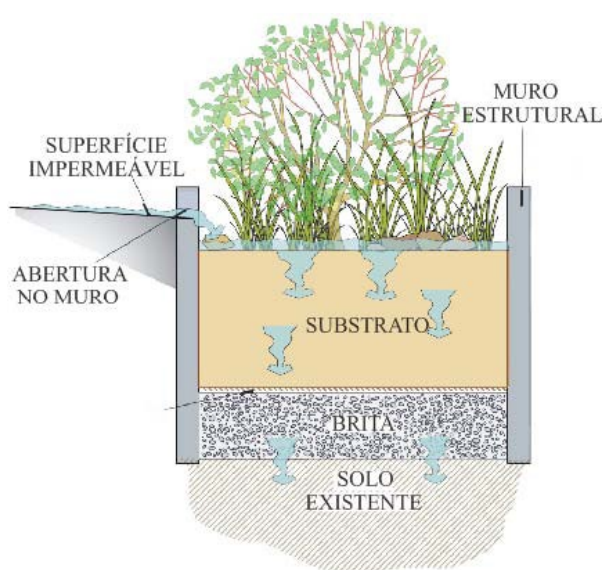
Diagrama esquemático de canteiro pluvial de infiltração.
